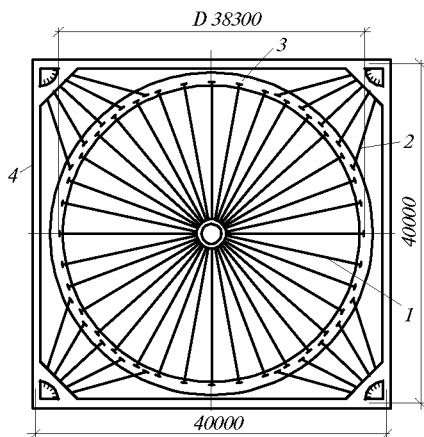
Железобетонная висячая оболочка, квадратная в плане; план покрытия рынка в Красноярске
